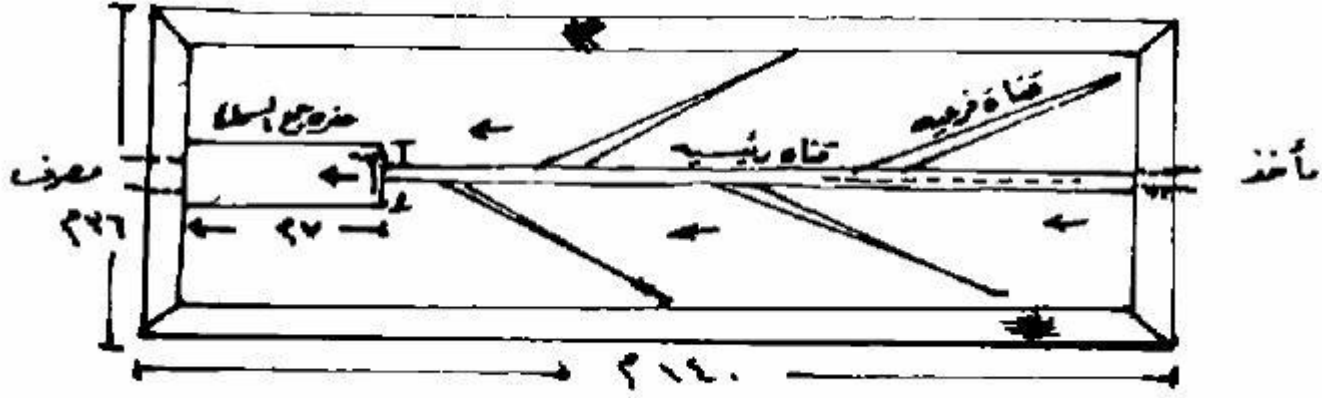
مسقط أفقي لحوض تسمين أسماك كارب ومشط
